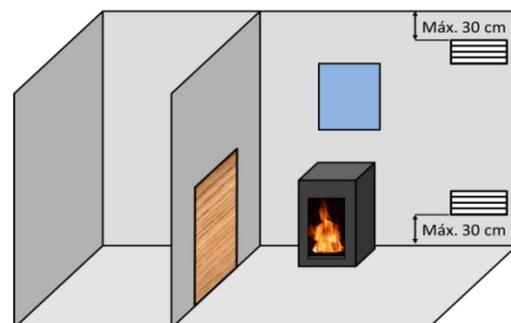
Schéma indicatif pour les grilles de ventilation
